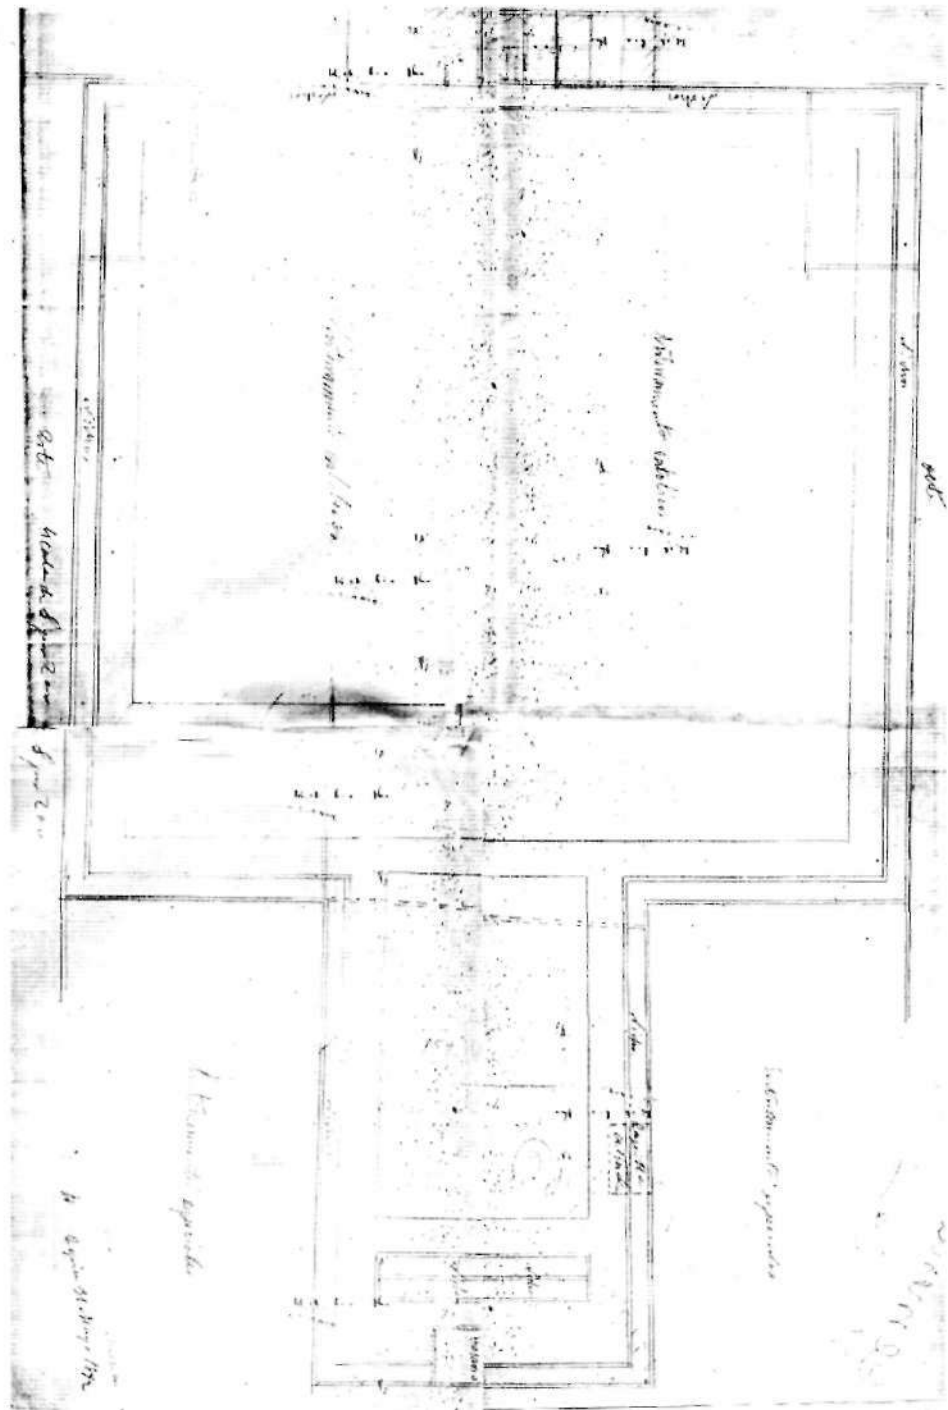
Plano de Justo Millán para la ampliación del cementerio.
